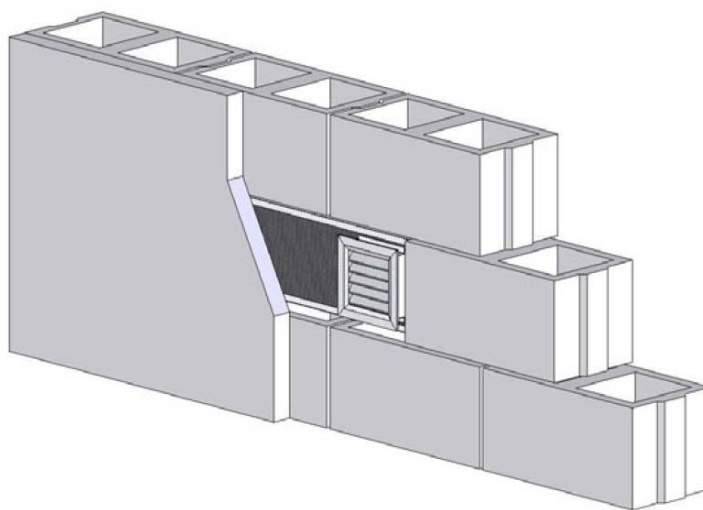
Schema di installazione della presa d'aria "Isobox" sulla parete di facciata.
